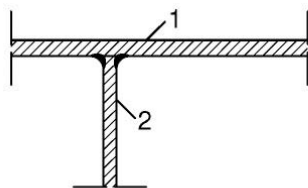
C.7 Soldaduras de la chapa de tablero en la dirección del carril de circulación con placa de respaldo metálica
